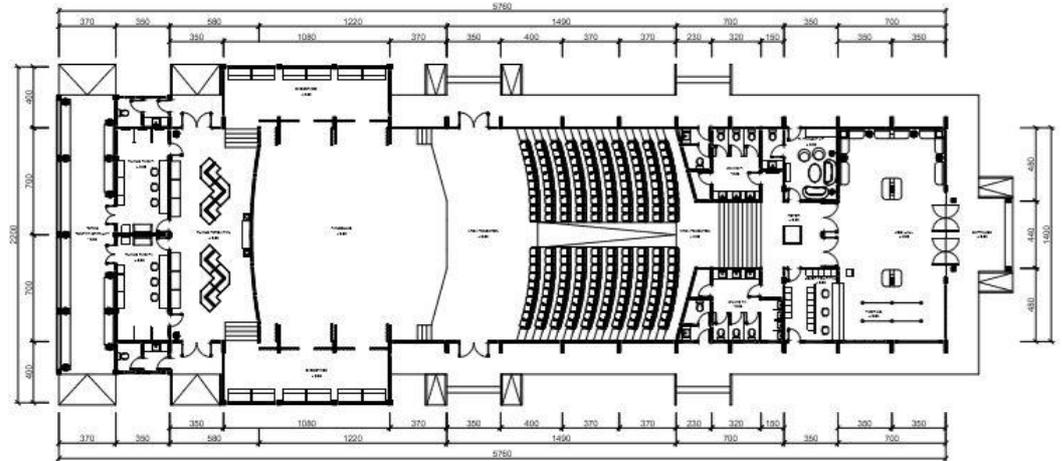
zoning dan sirkulasi alternatif 2 lantai 1
